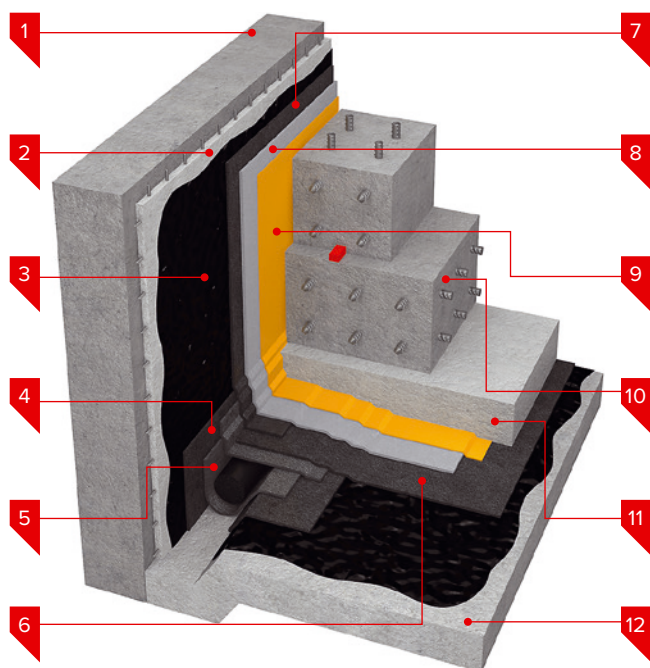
Техноэласт Фундамент ГИДРО. Зона подошвы фундамента. Вариант со сплошной приклейкой к основанию:
